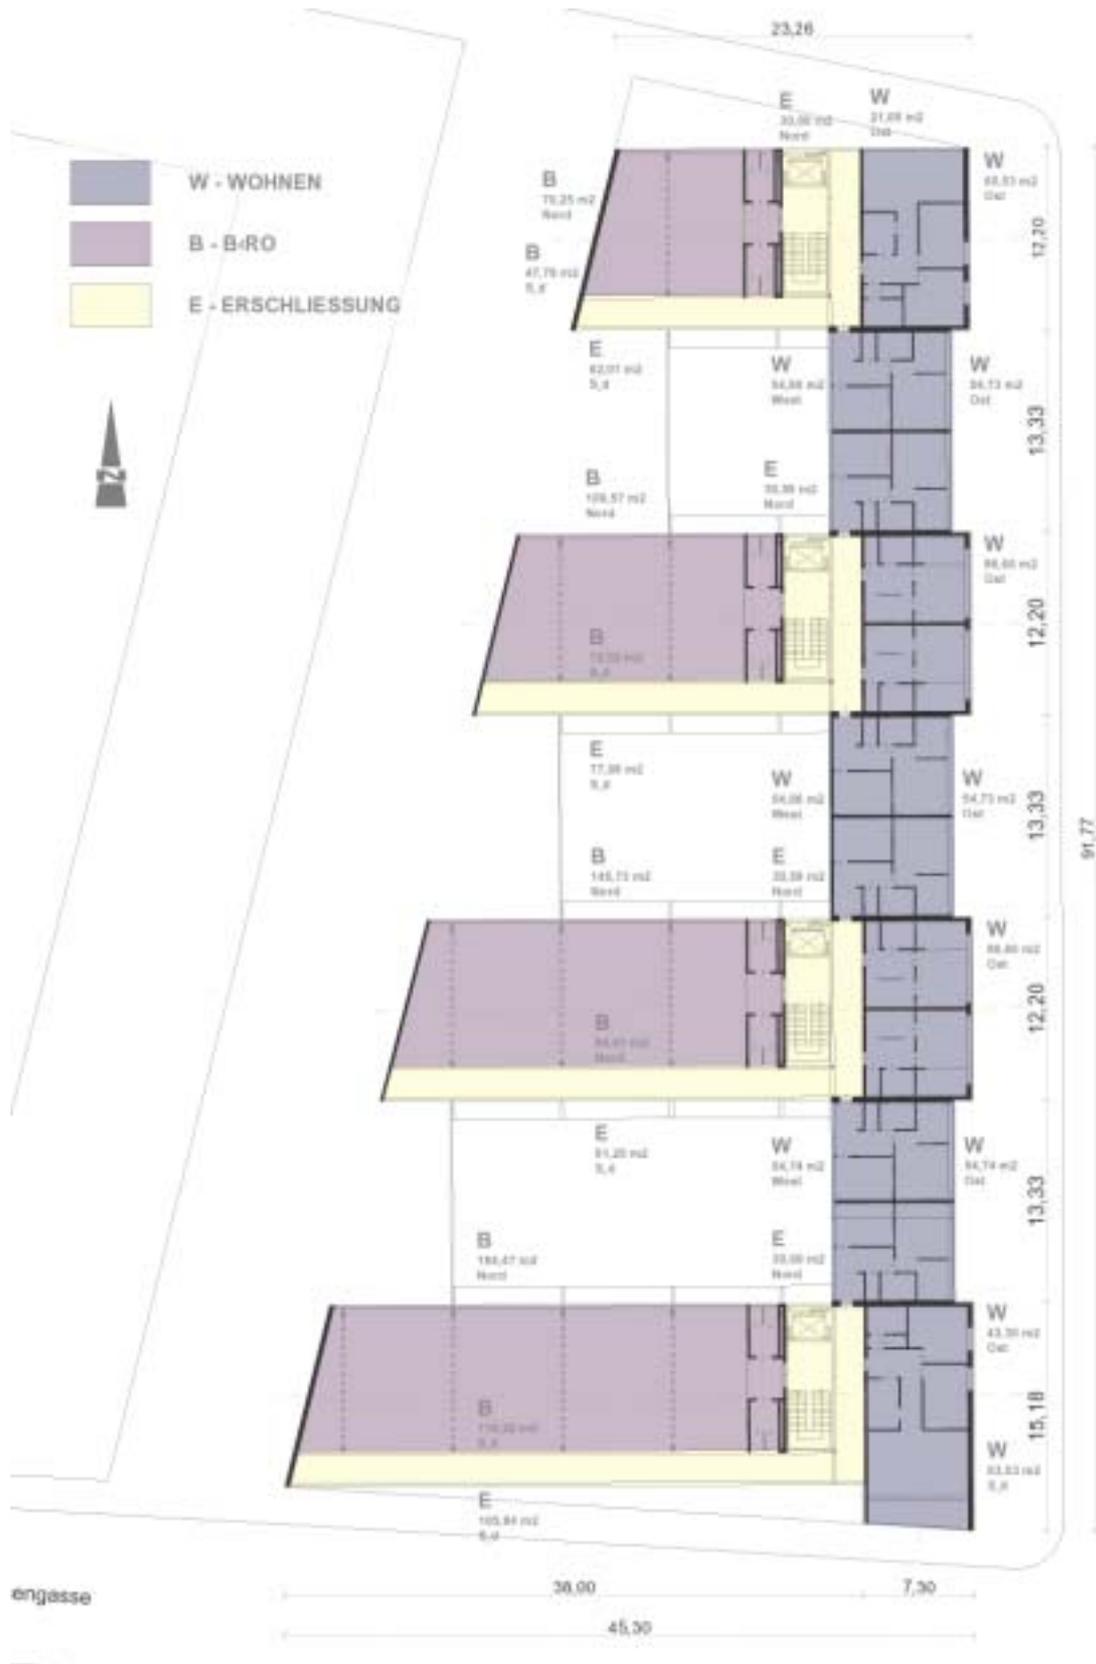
Mayssengasse, Grundriss Regelgeschoss, M = 1:500
